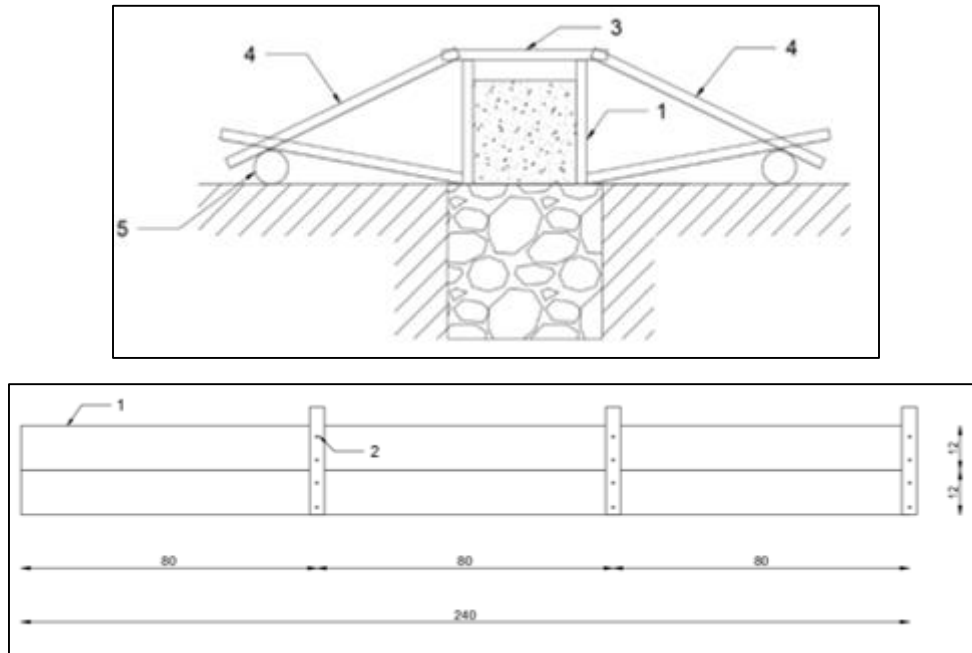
Detalle del encofrado de las cadenas de amarre
